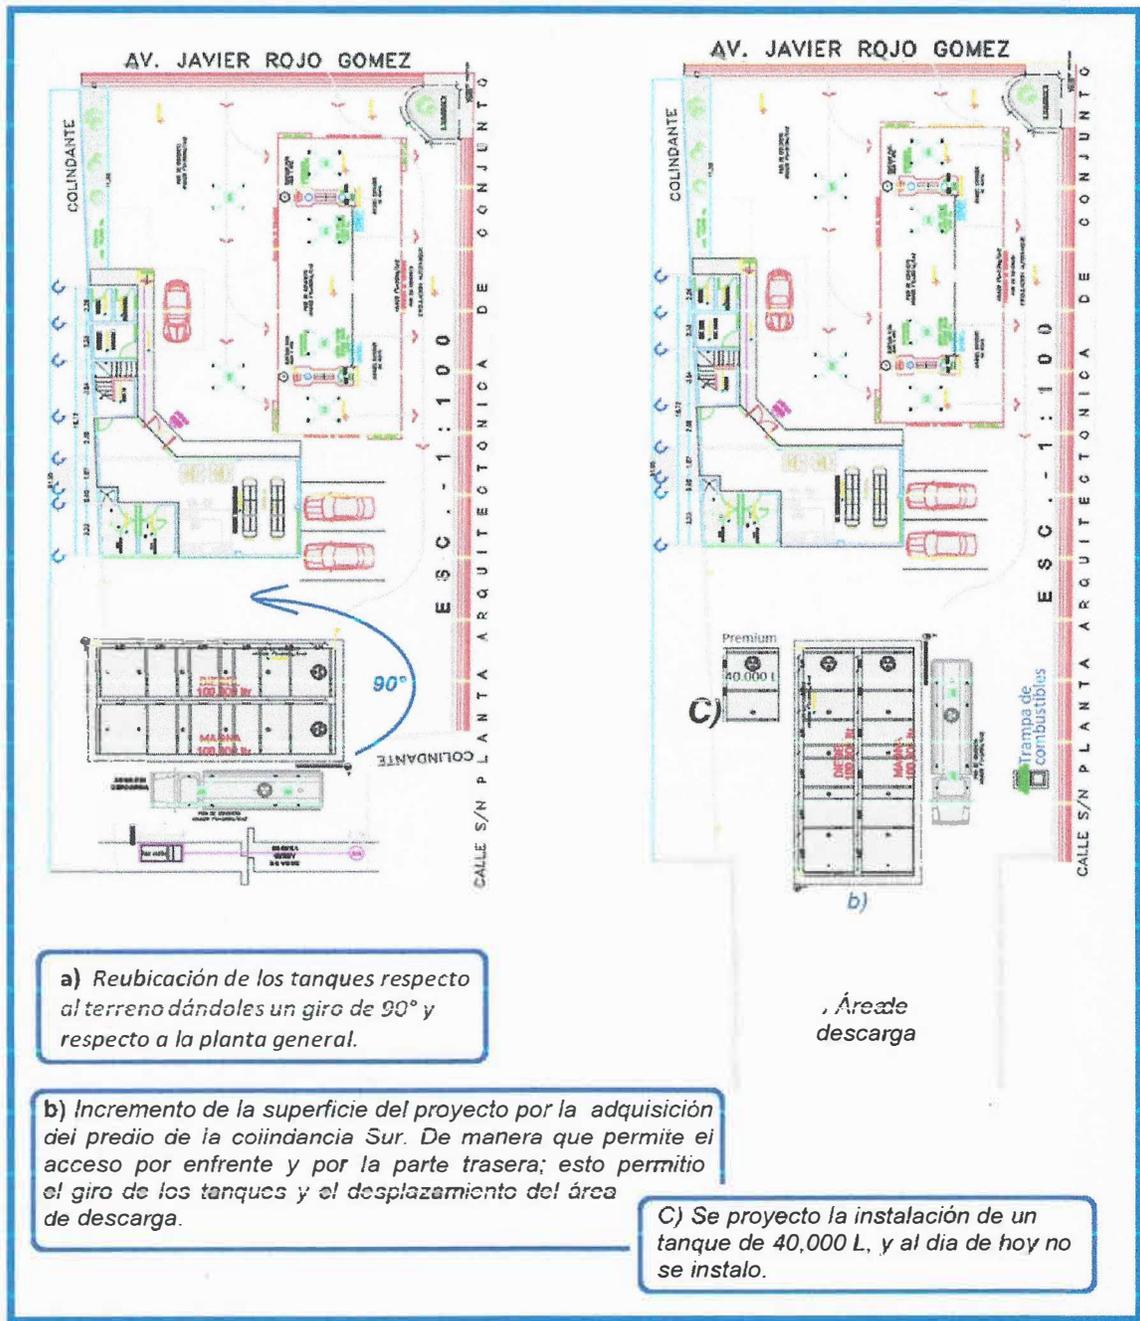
Reubicación de los tanques con giro de 90° en respecto al terreno y planta general.
